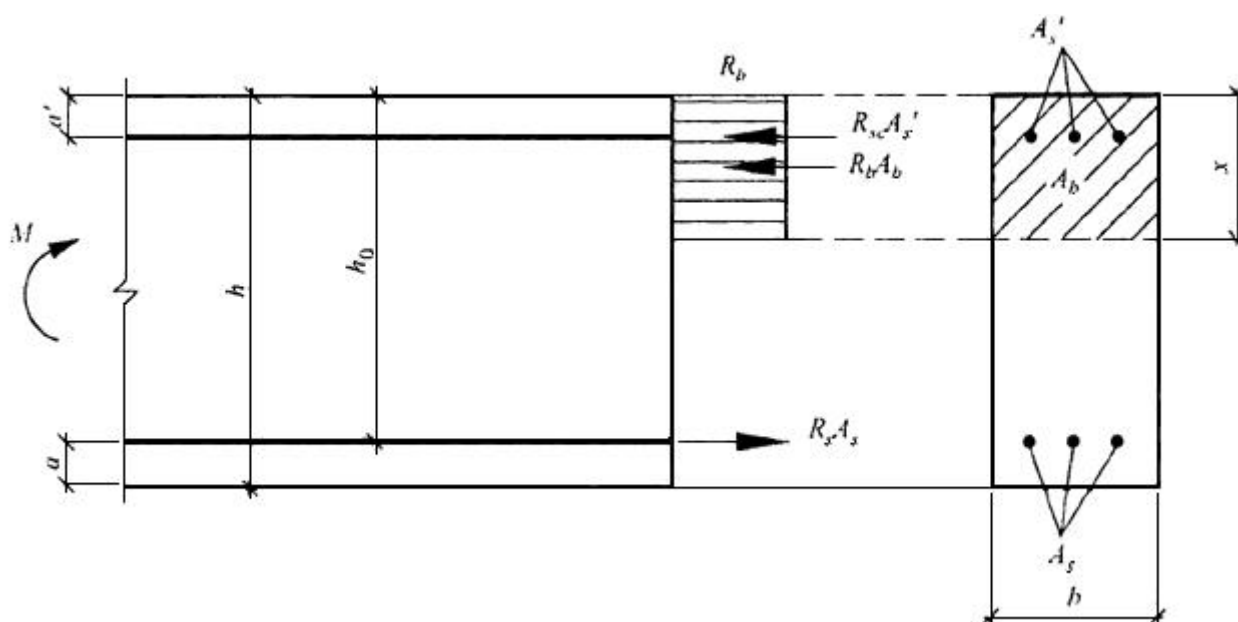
Схема усилий и эпюра напряжений в поперечном прямоугольном сечении плиты перекрытия прямоугольного сечения
